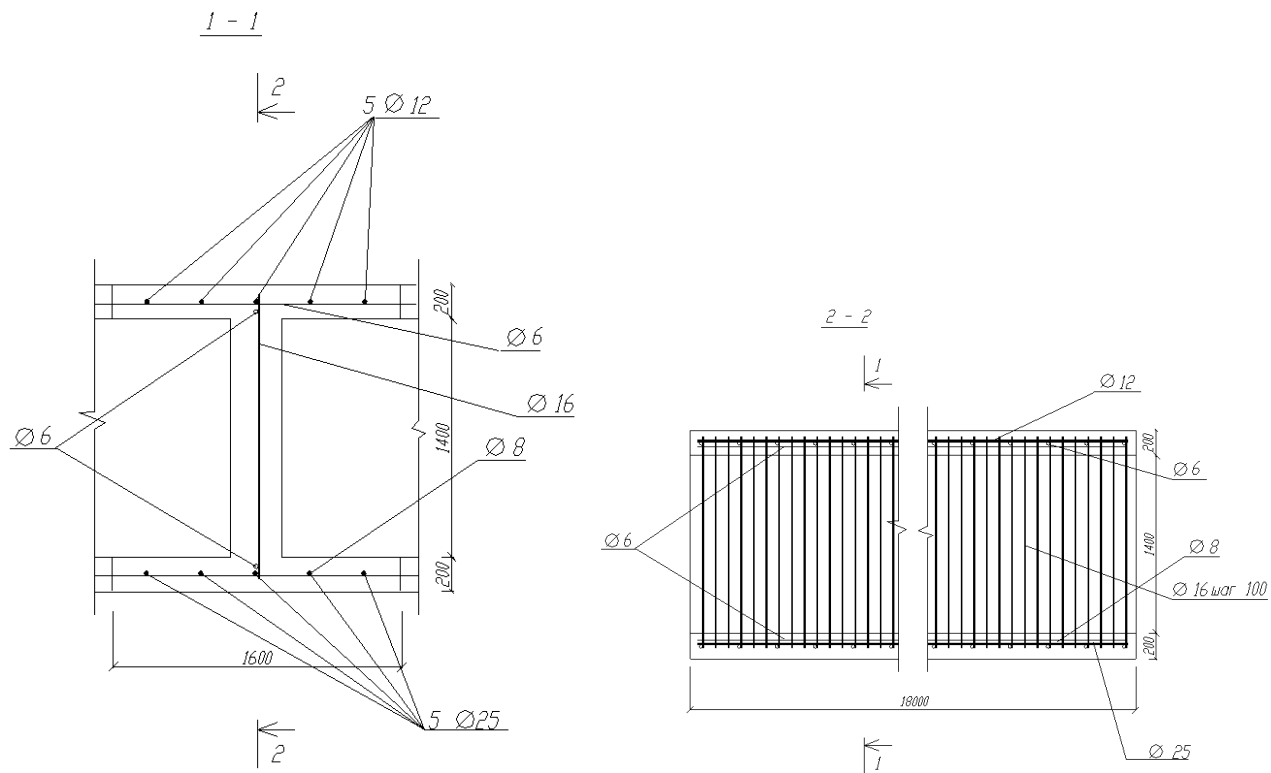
Схема армування фундаменту на ділянці між осями Б – Г і Ж – Л.
